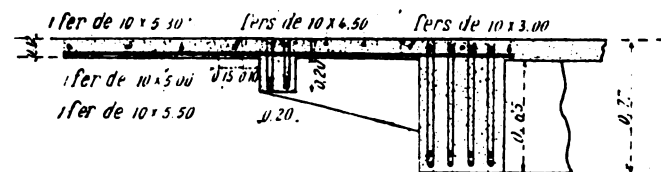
Coupe de l'encorbellement en dehors des poutres intermédiaires.
